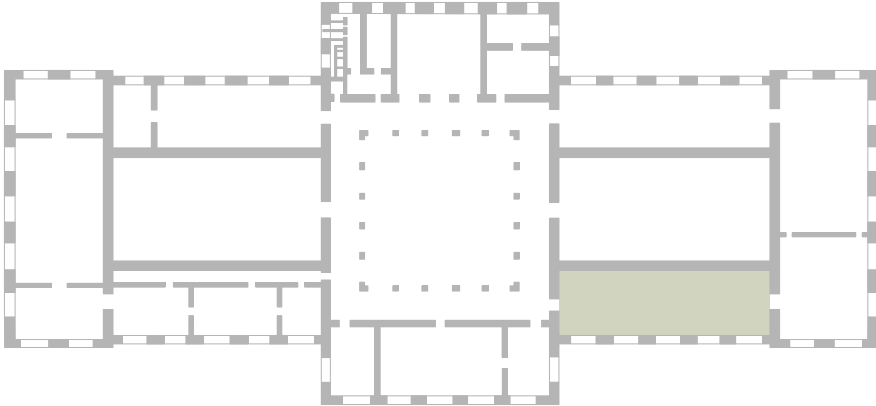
Museum für Angewandte Kunst (MAK), *Grundriss 1.Obergeschoss*, Wien, o.J.
